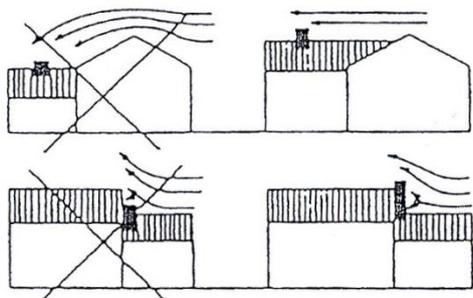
cheminée de la construction existante lors de la réalisation d'une nouvelle construction
